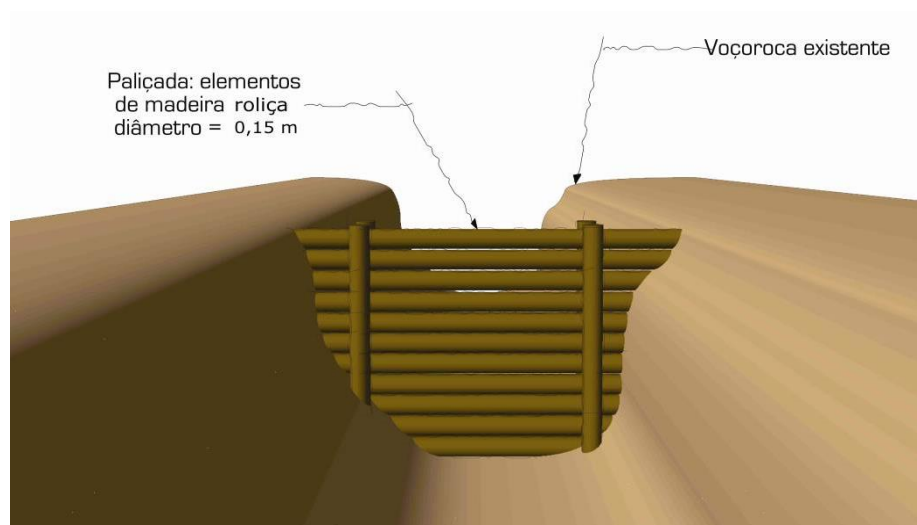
Vista superior do modelo construtivo de paliçada proposto.
